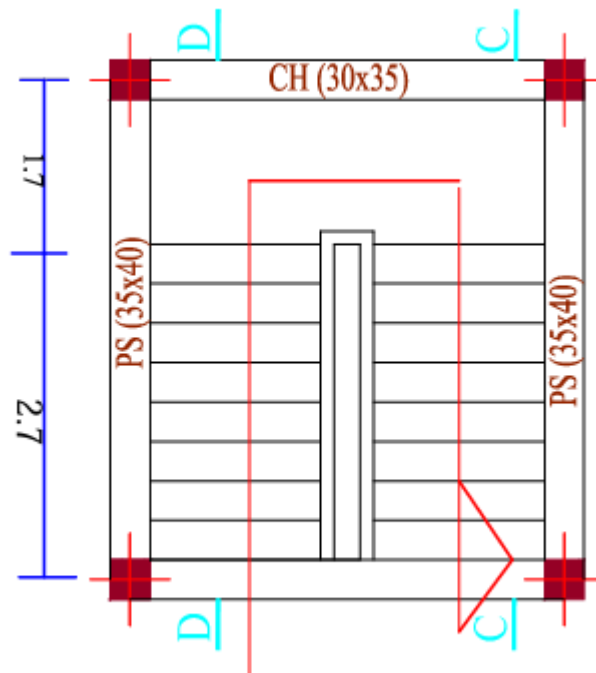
Vue en plan pour les escalier (Etage)
